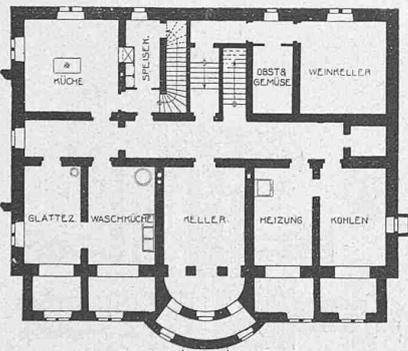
bis 6. Grundrisse 1:400.
